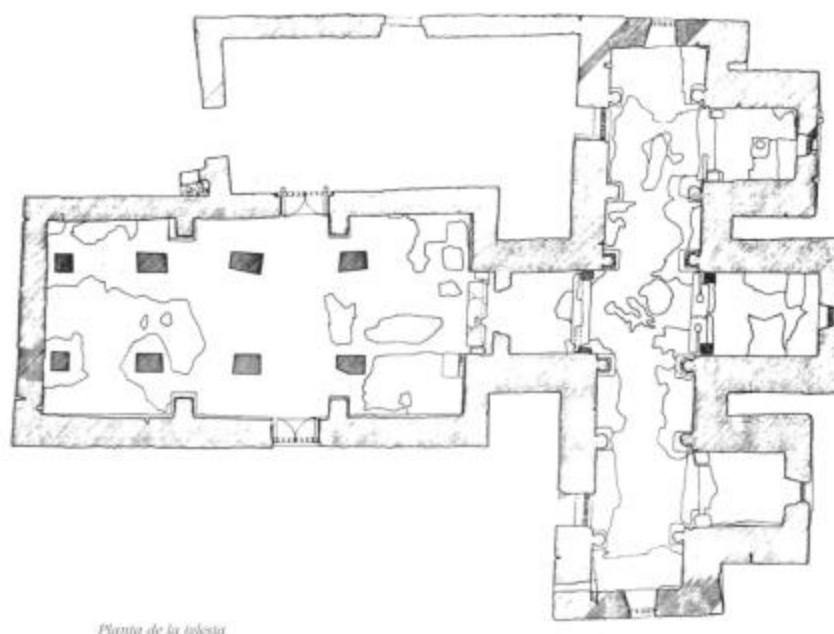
Planta de Santa Lucía del Trampal, Alcuéscar (Cáceres), siglo VII.
